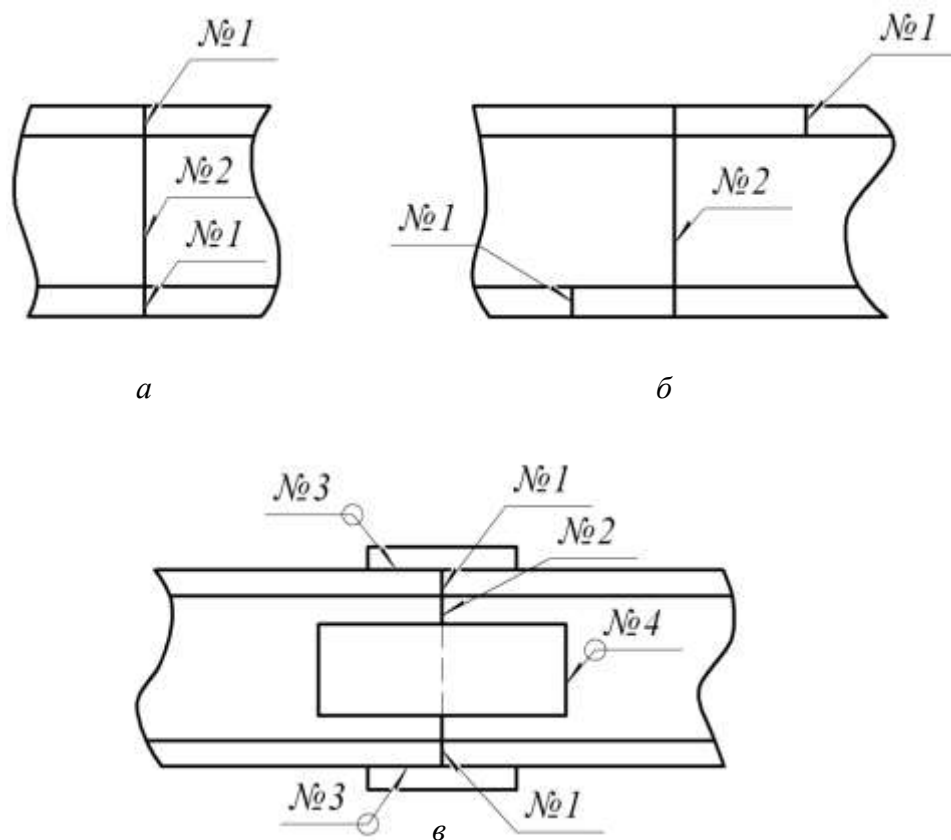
Технологические схемы сварных стыков стойки сплошного двутаврового поперечного сечения: а – прямой стык ; б – разведенный стык; в – стык с накладками и планками
